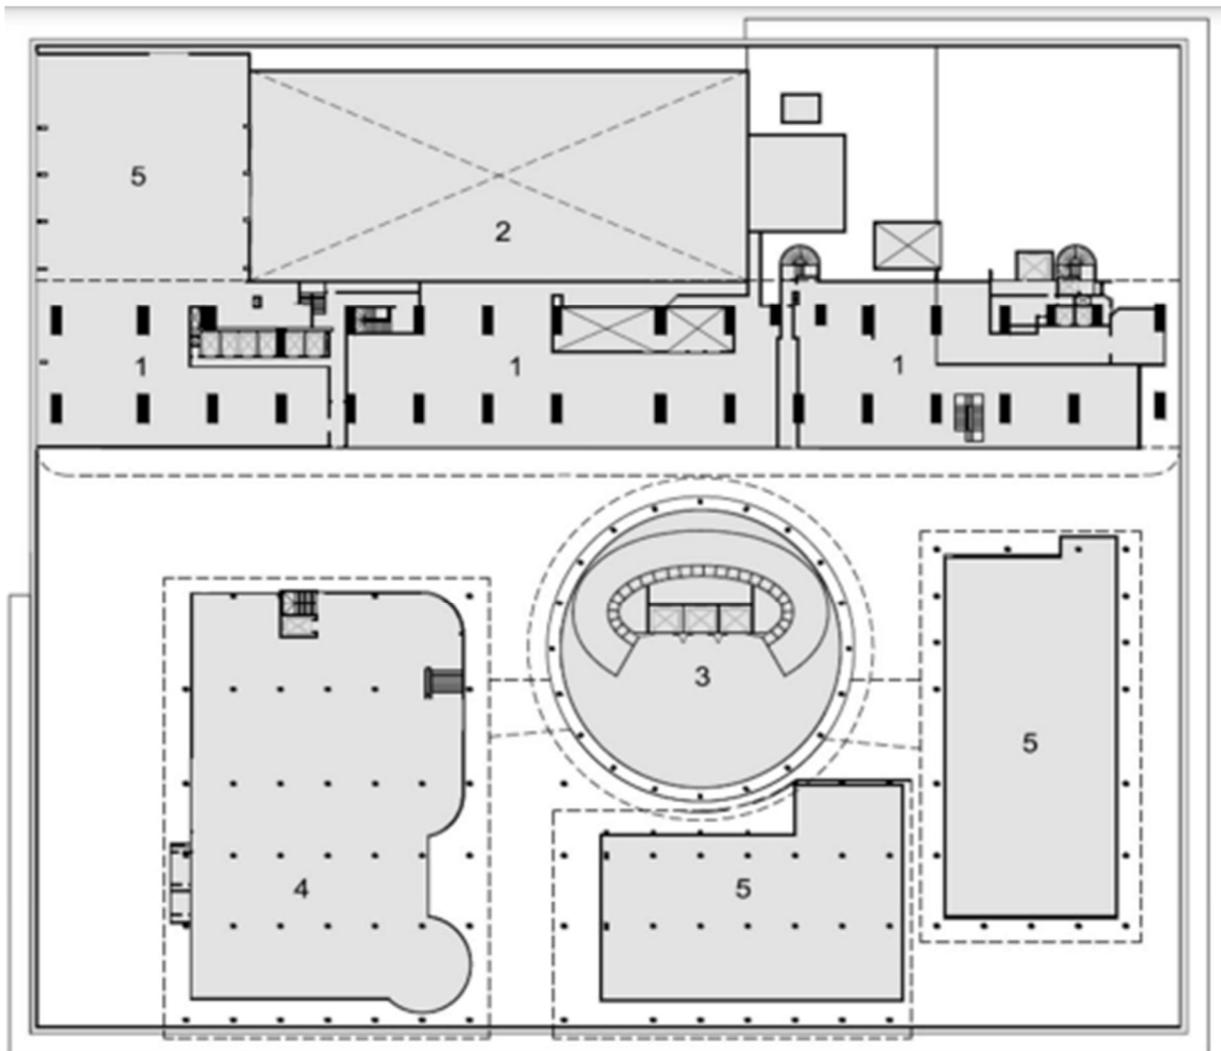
2º pavimento Conjunto Nacional. Fonte: (FRAU, 2016)
